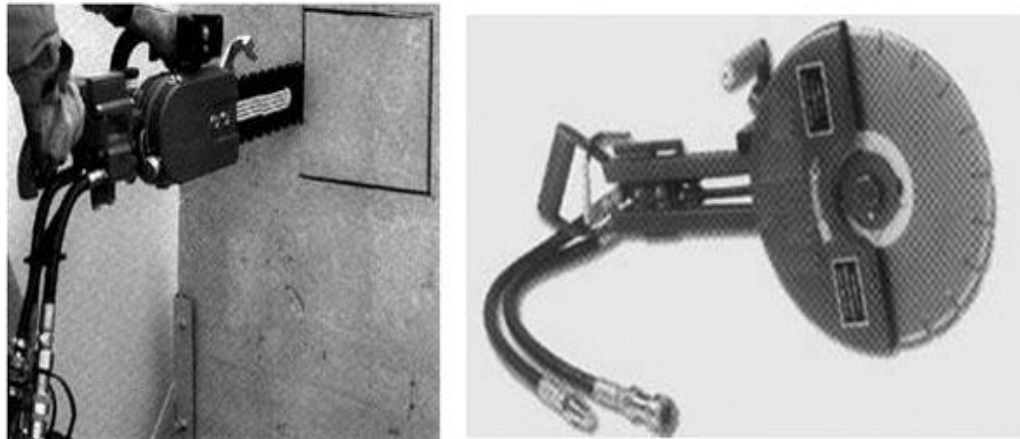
Remoção de betão por corte; construironline.dashofer.pt
